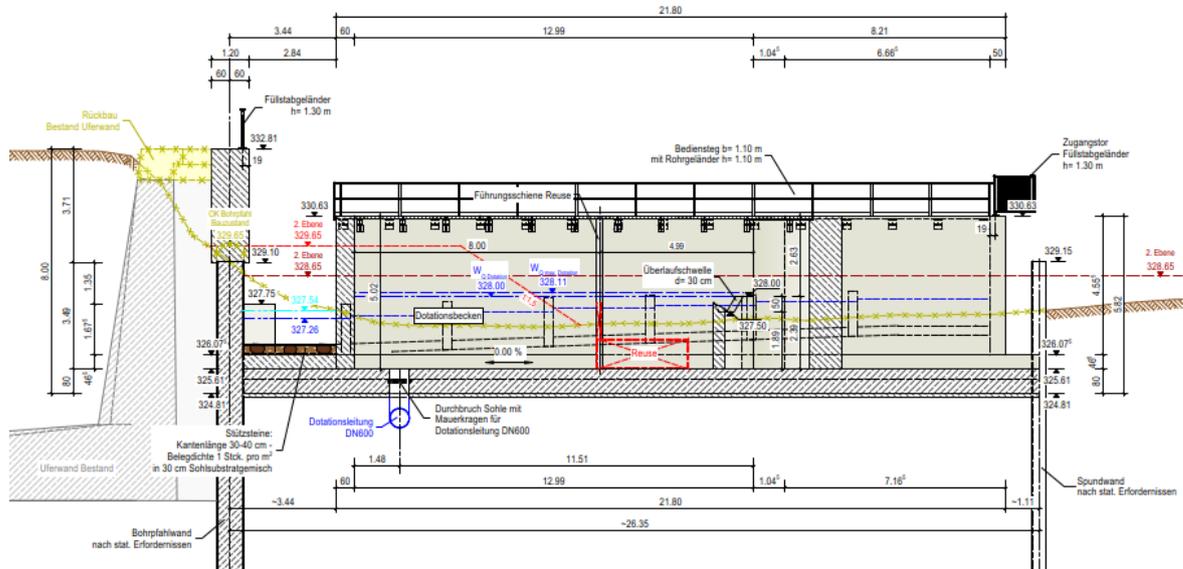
Schnitt 2-2 Einstiegsbauwerk – Dotationsbecken
